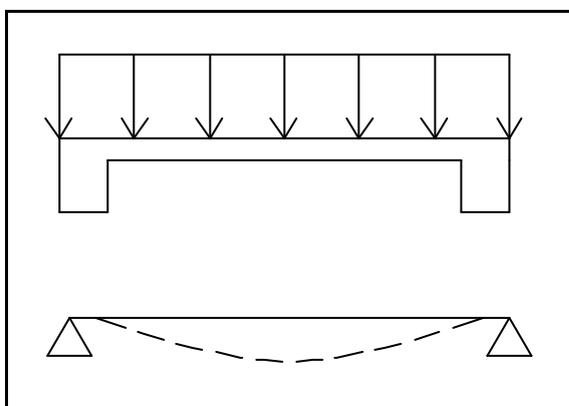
Corte de uma laje apoiada em duas vigas de grande rigidez
